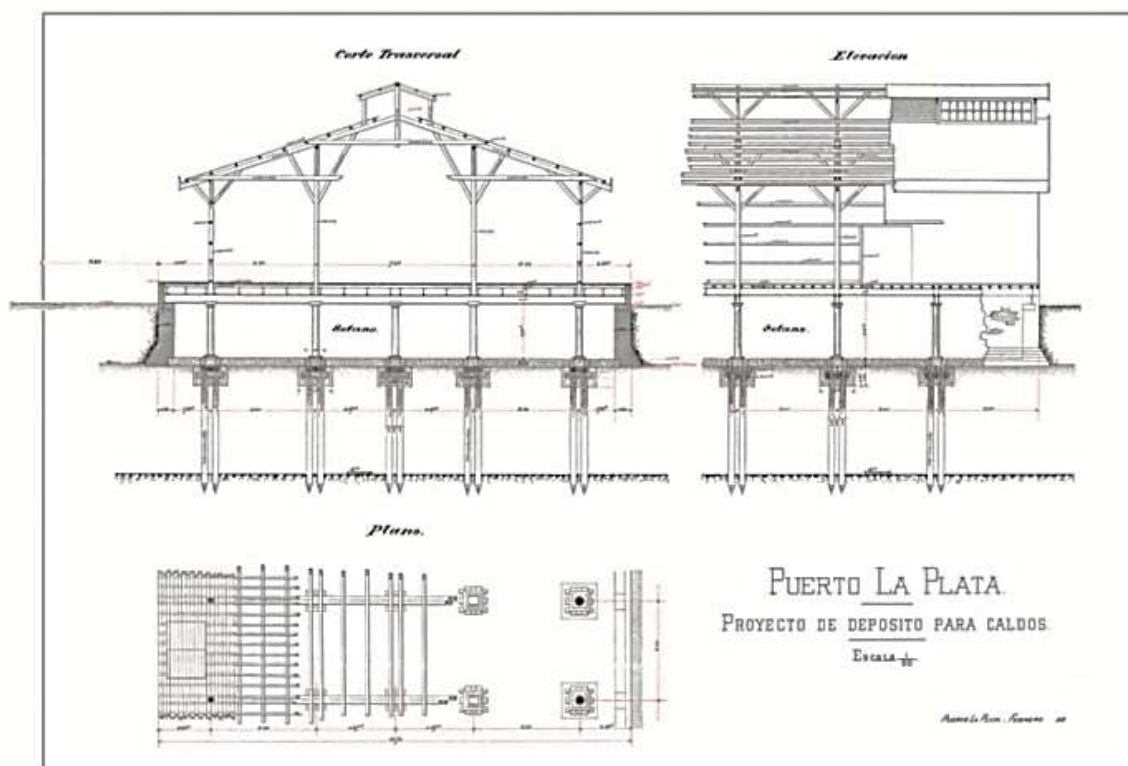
Plano de proyecto de “Depósito de Caldos” (líquidos inflamables, sin fecha)
